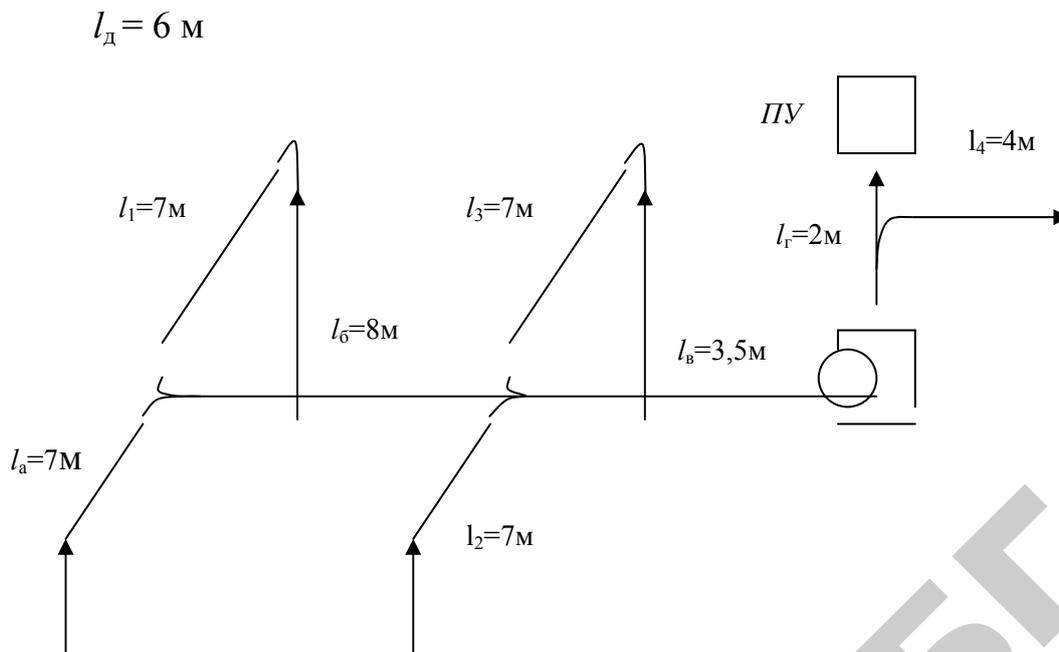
Схема воздуховодов вытяжной вентиляции
